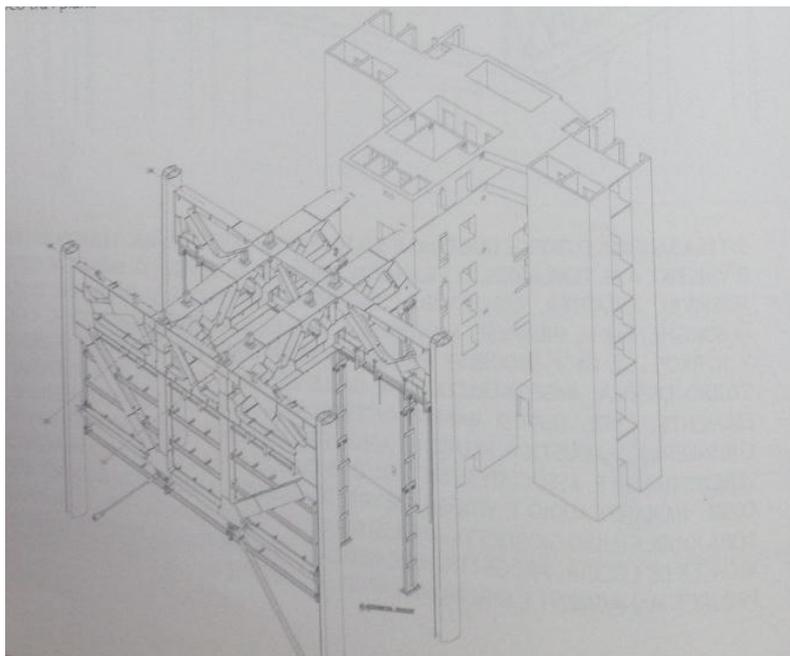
Schema strutturale dell'edificio (Fonte: Rivista Modulo N° 390)
